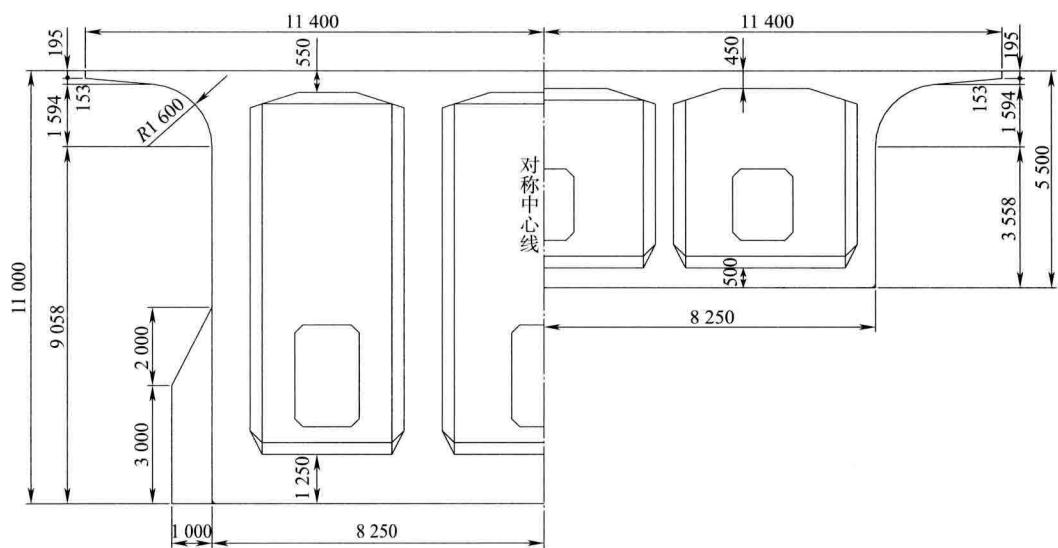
连续梁箱梁横截面示意图(单位:mm)
